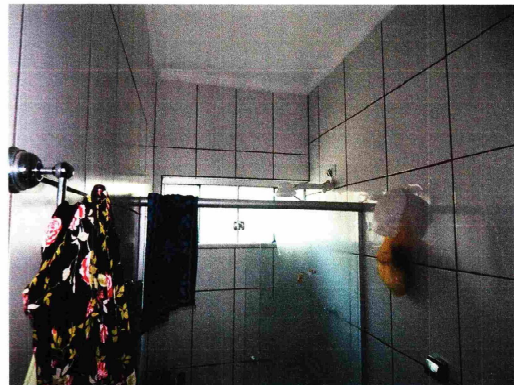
VISTA INTERNA BANHEIRO QUARTO III - APT0
